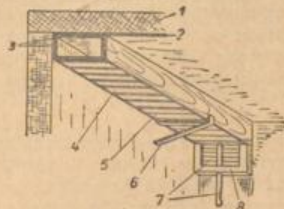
1. Massivdecke, 2. Deckenputz, 3. Bretter 24 mm oben 1 Stück, seitlich je 2 Stück, 4. Bretter 20 mm 12 cm breit im Abstand von 1—2 cm genagelt, 5. Bretter 20 mm von der Wand weg ca. 1,20 m genagelt, 7. Absteckschieber mit Steckstange, 8. Führungsrahmen.
